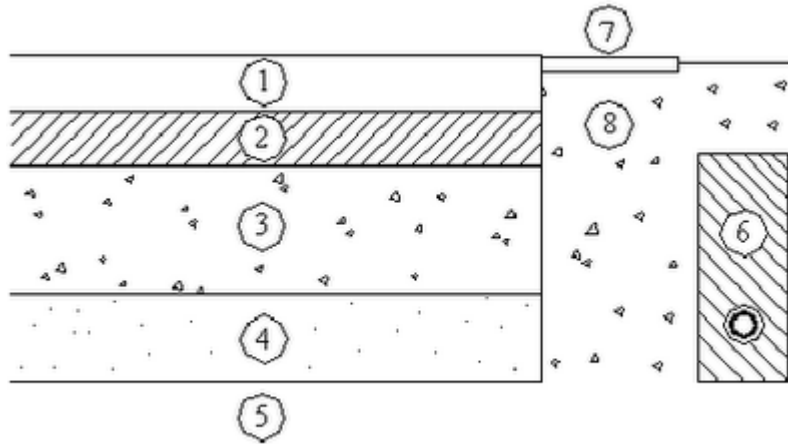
Cueva Ing. Civil, Instituto Tecnológico de Aeronáutica, Ingeniería de Pavimentos.
